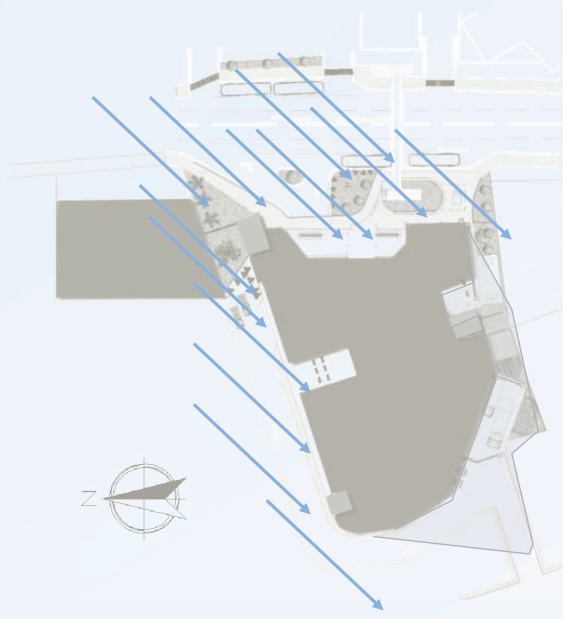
Dirección de la Lluvia en las fachadas. Sin escala.
